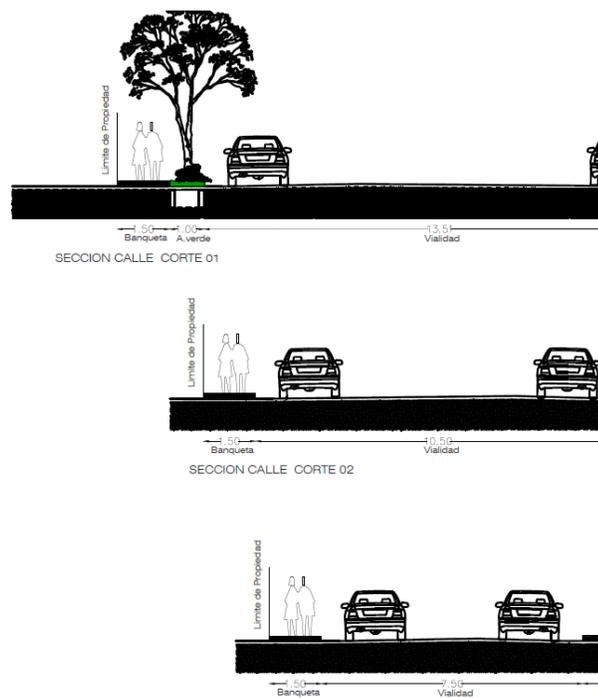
Croquis de la calle, estos se encuentran en los planos anexos al estudio.
